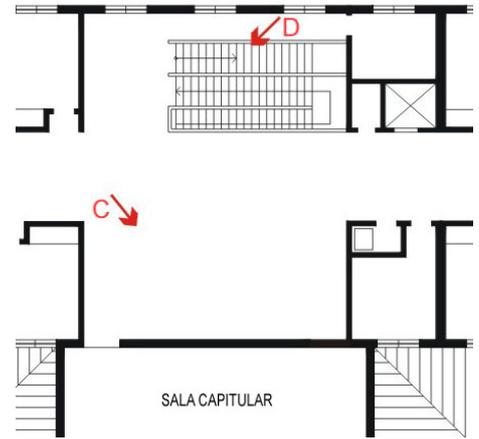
Hall de circulação 2º Pavimento, versão construída. (Desenho da autora).
